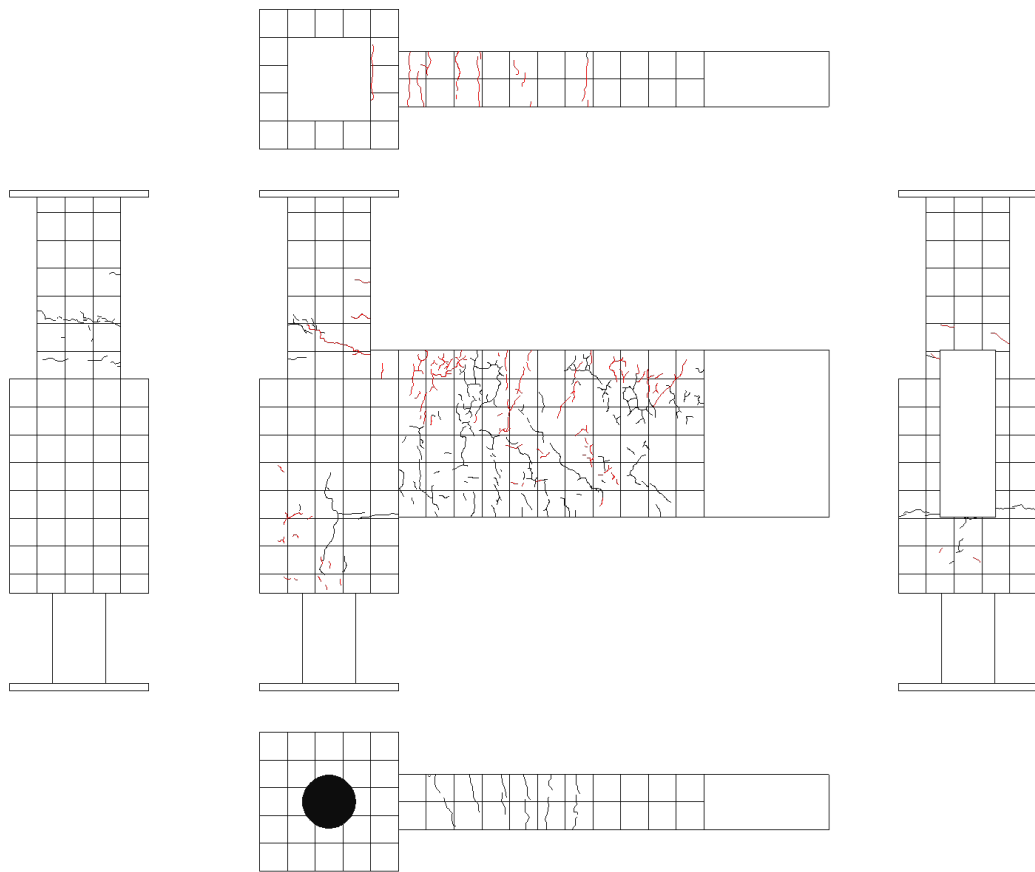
試験体 A-7b ひび割れ状況 (1Cycle)
